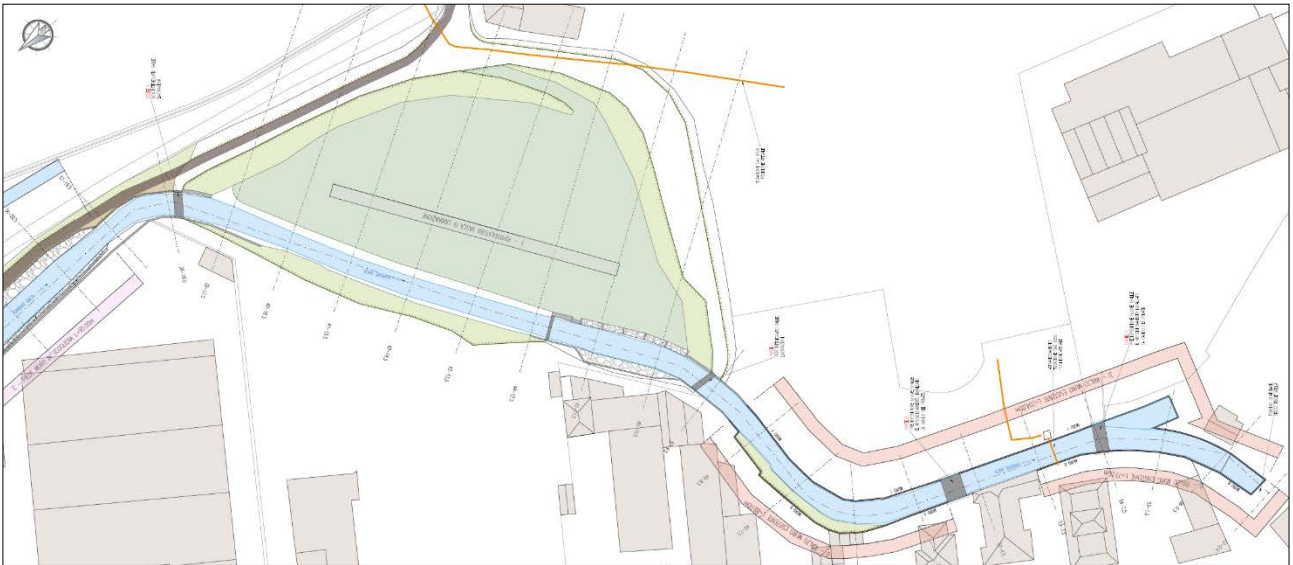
Estratto Tavola 04. Stato di progetto, planimetria generale.
